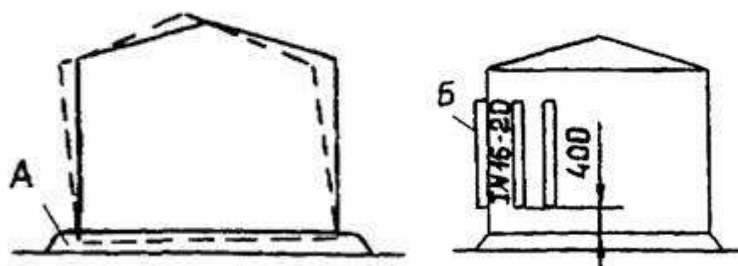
(А - неравномерная осадка резервуара, Б – приварные рёбра жесткости).
